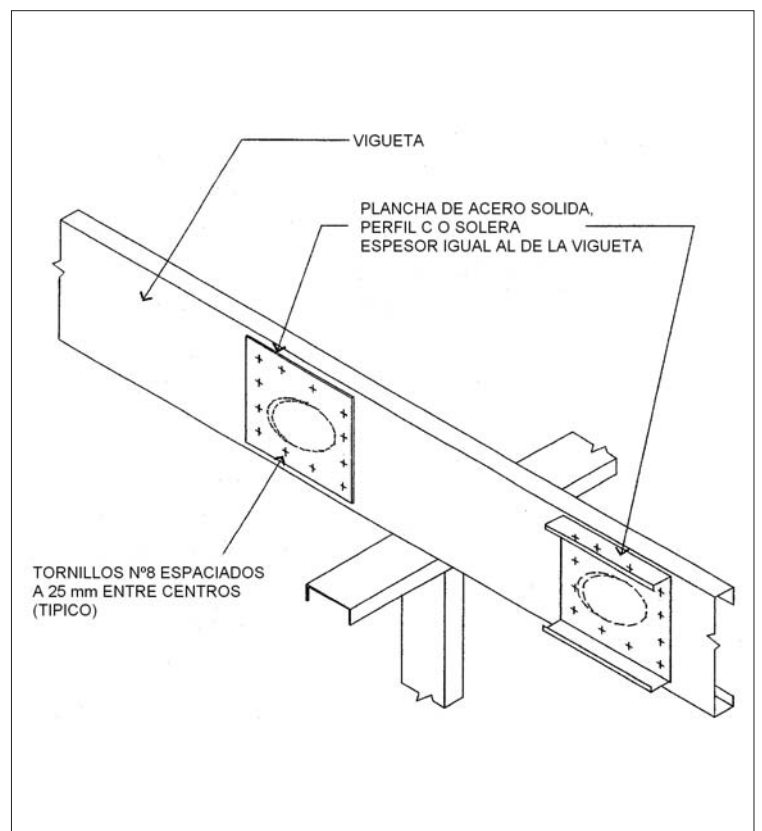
Refuerzo de Perforación de Perfil Vigueta
